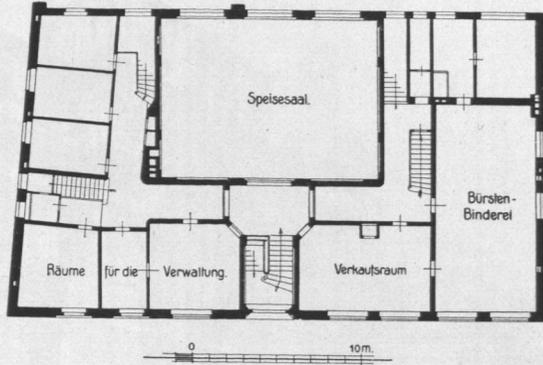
Blindenanstl, Erdgeschoß, Grundriß.
